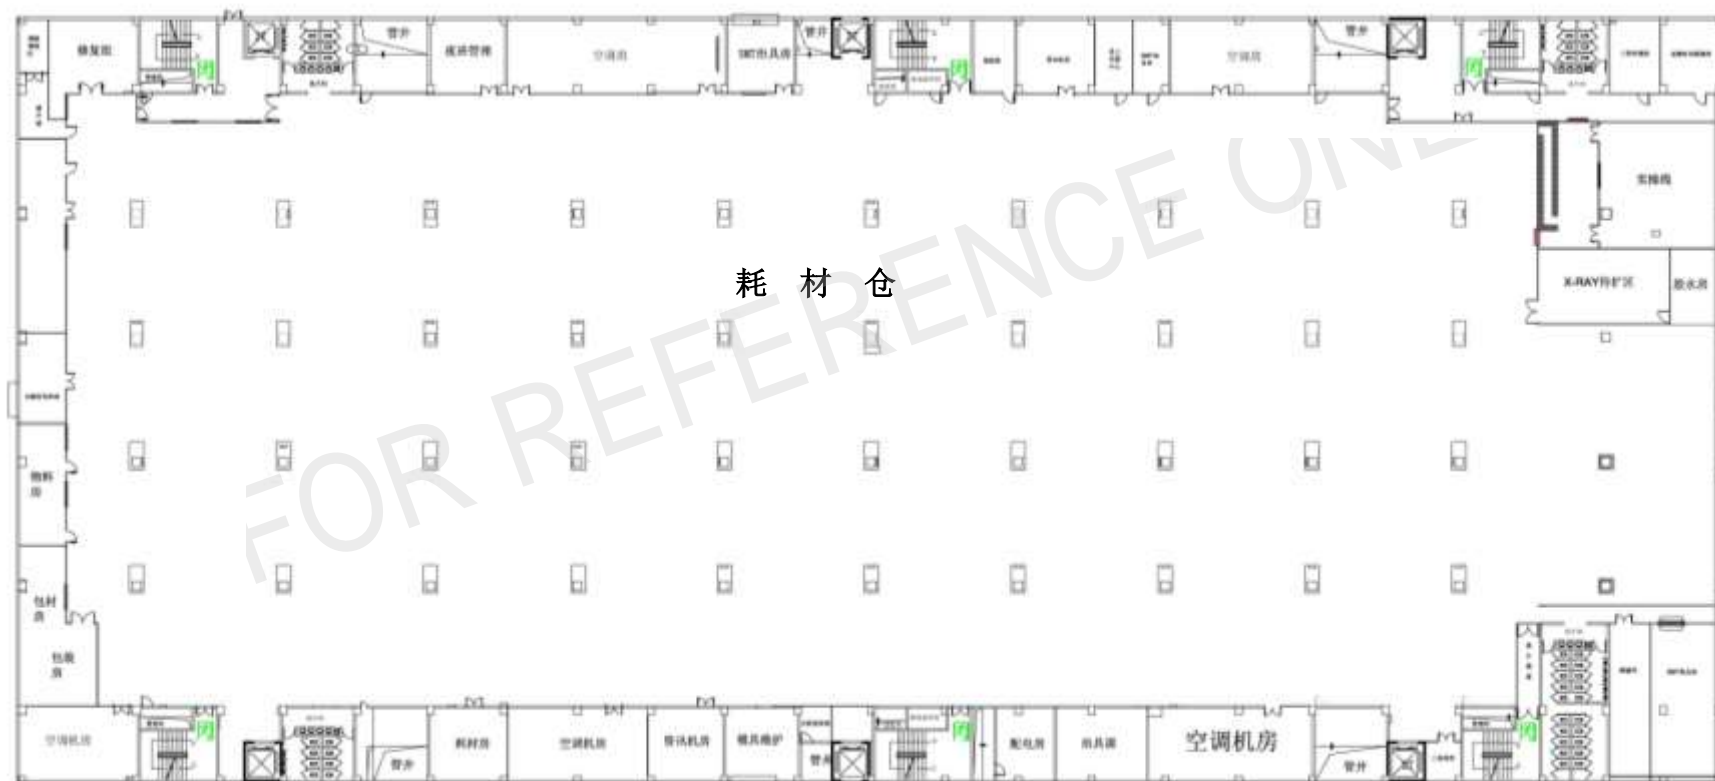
鹏鼎公司 A2 栋厂房四层车间平面布置图
